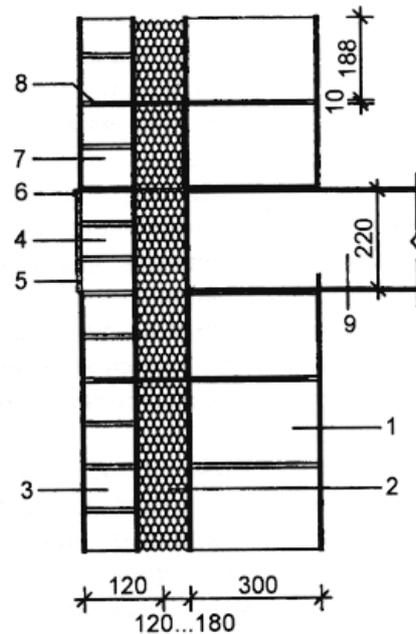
Наружная стена из ячеистобетонных блоков с облицовкой кирпичом:
